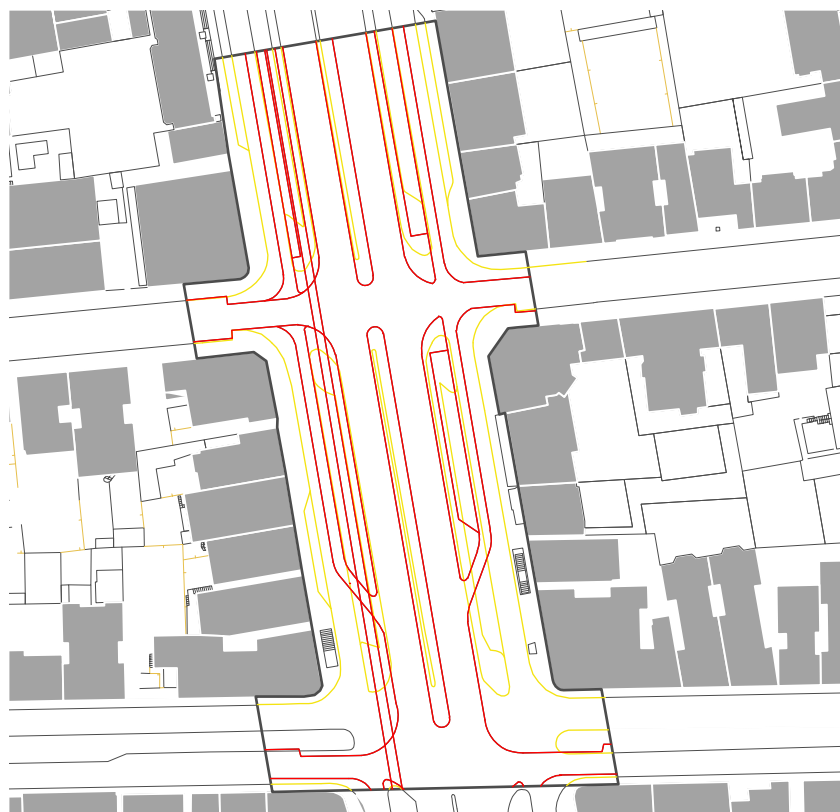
Planta de Amarelos e Encarnados, alterações da Avenida da República
